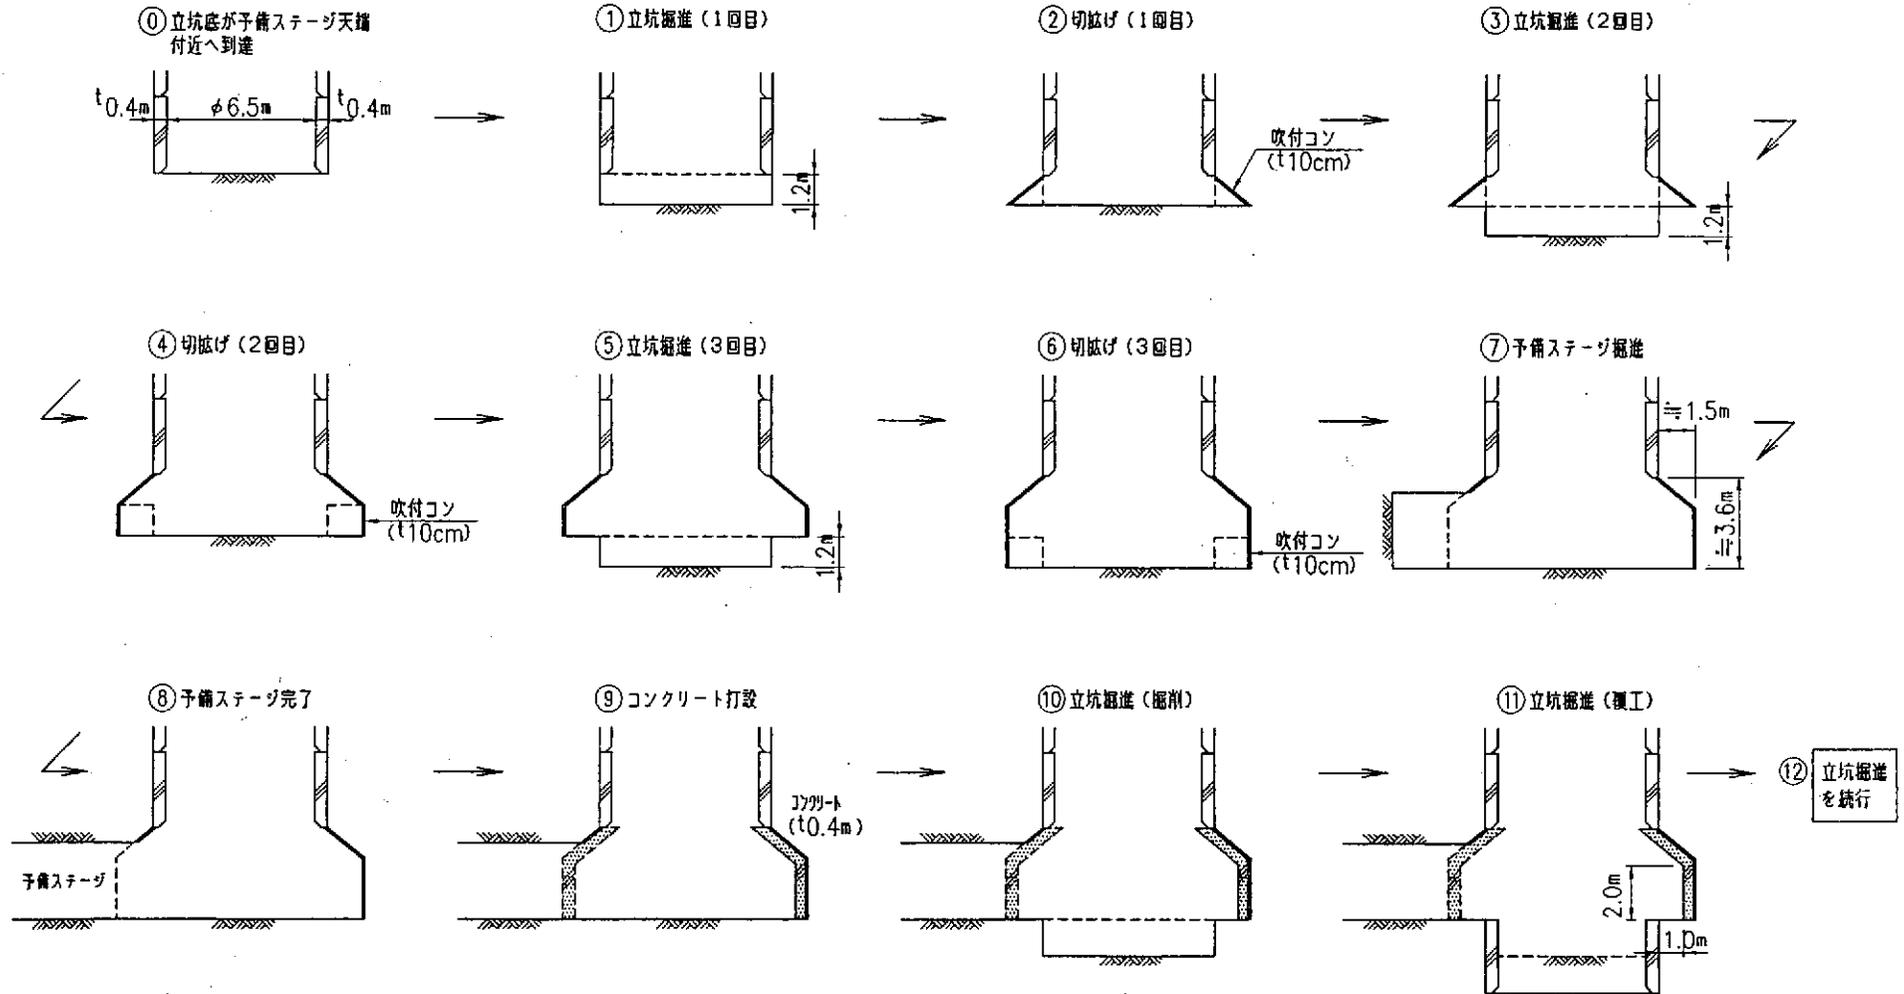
主立坑と各ステージとの分岐部の施工手順
